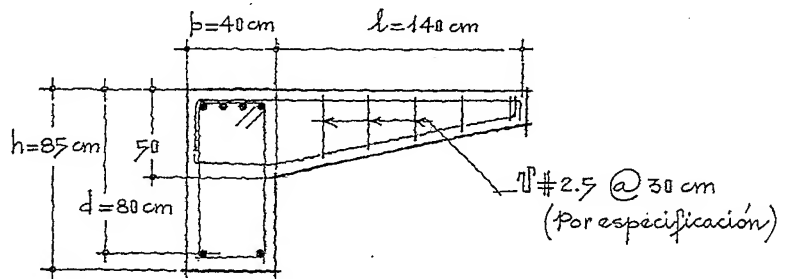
Corte transversal de la viga principal y la viga en cantilever.
